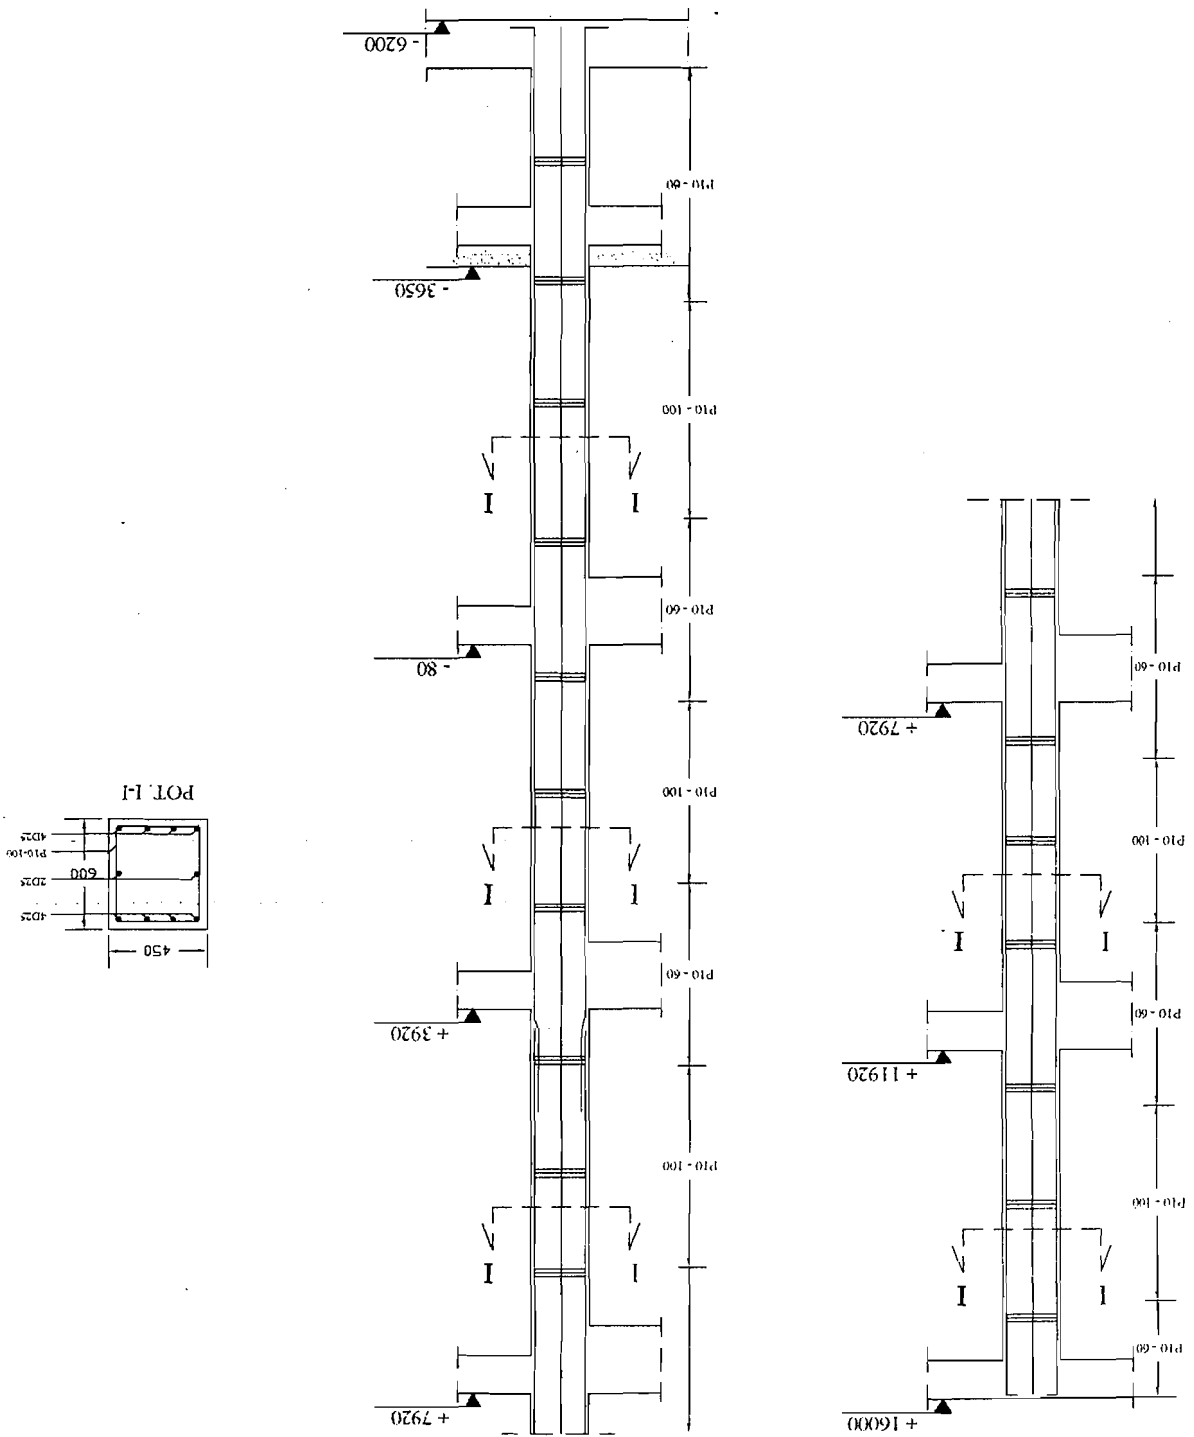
Detail Kolom KA2 As K7 s/d As K11
